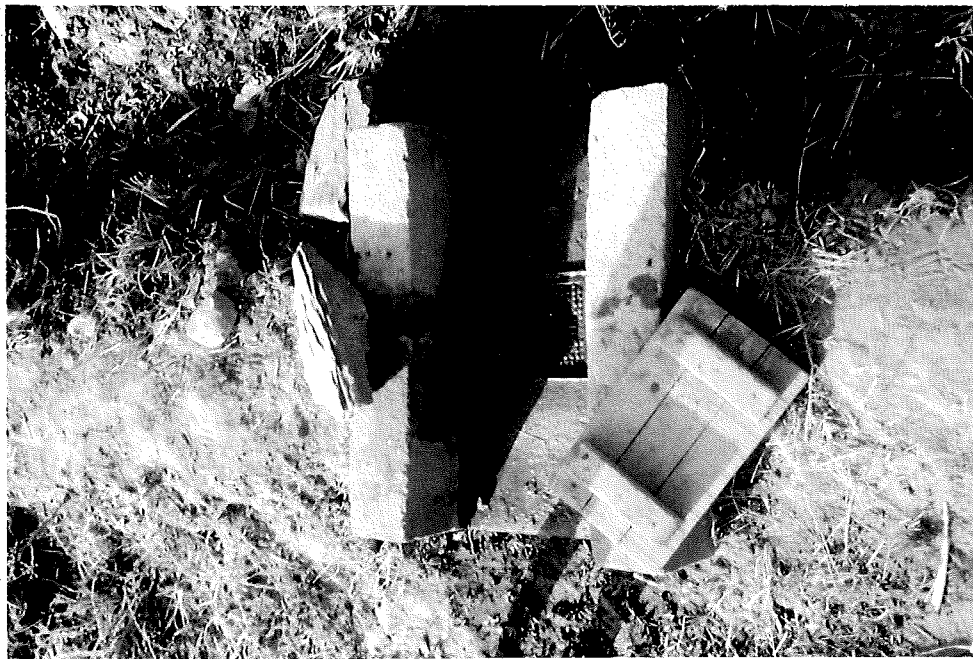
Offener Auslaßschacht der Rohrbevässerungsanlage.
